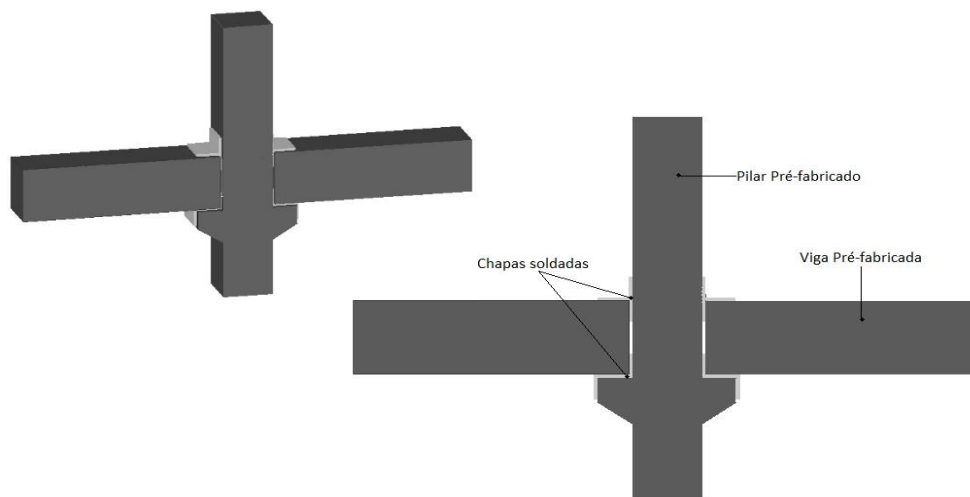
Ligação Viga – Pilar por chapas soldadas
